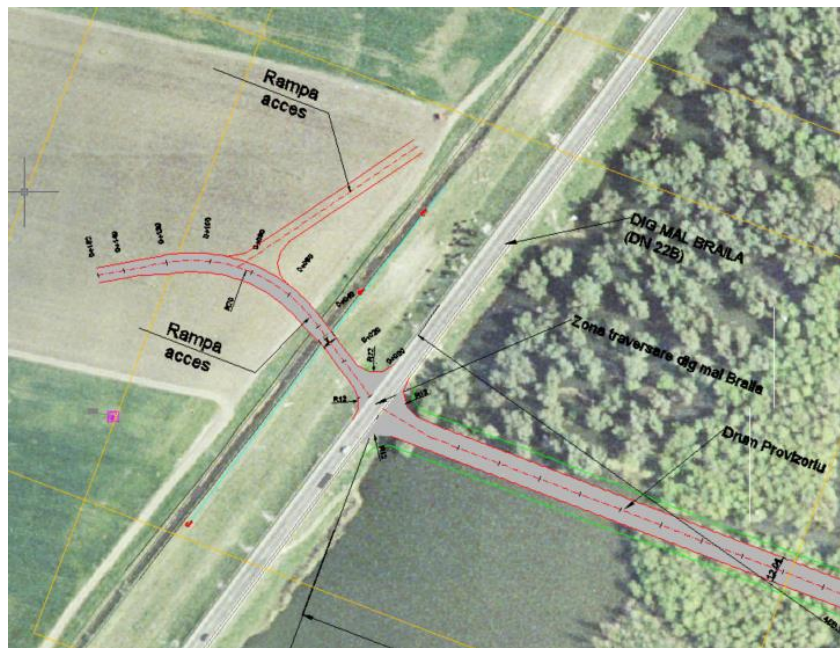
Plan situație - intersecție temporară DN 22B
